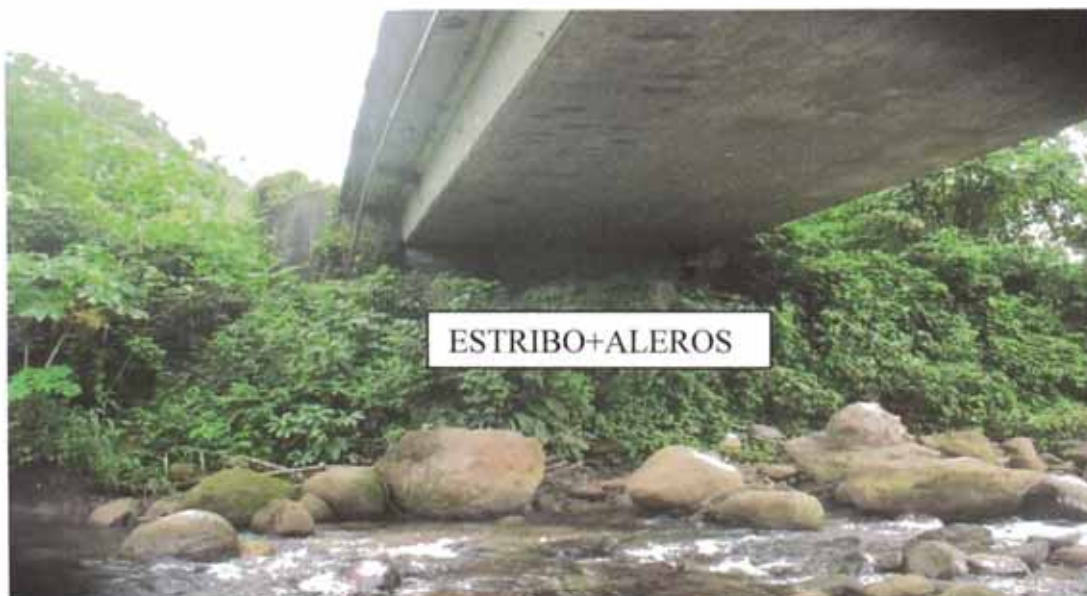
Vista actual del estribo + aleros del Puente Nochoz.
